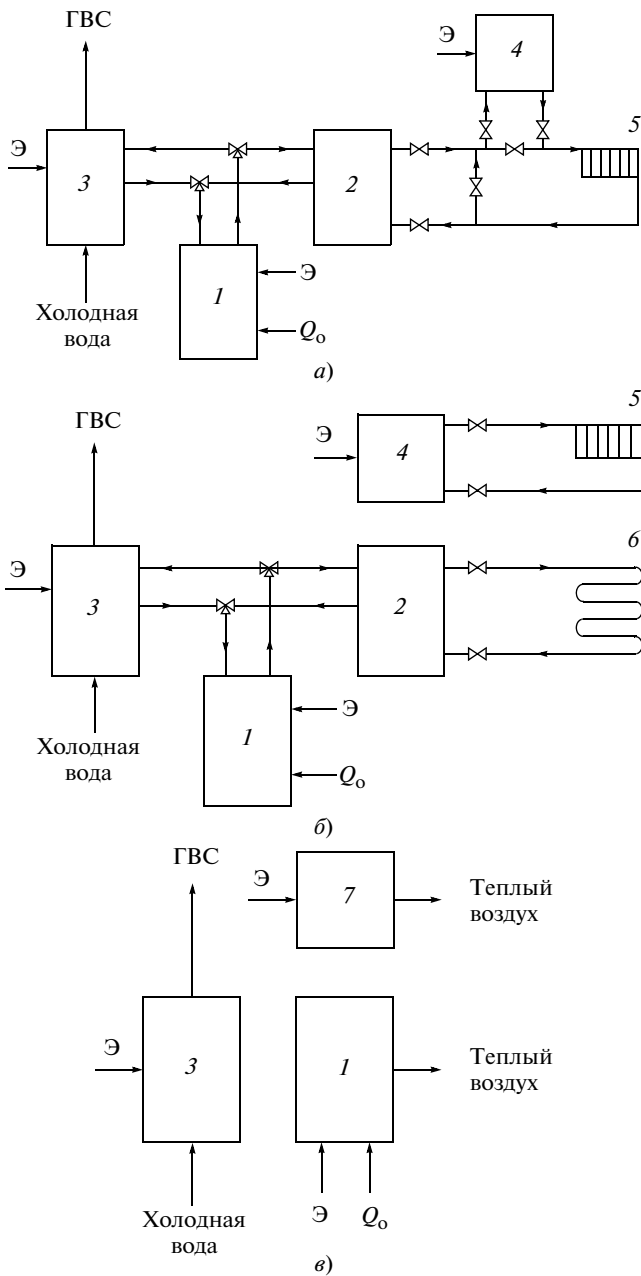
Схемы теплоснабжения индивидуального дома с ТНУ.
